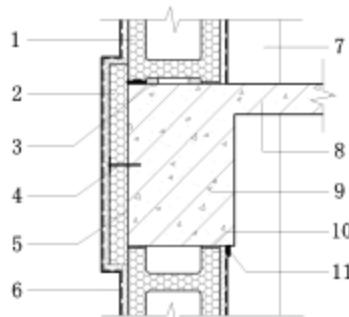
边梁外保温与墙体连接组合构造示意（垂直剖面）
